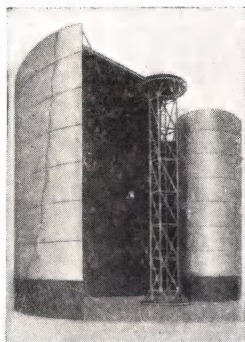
Полуразвёрнутый рулон, образующий стенки цилиндрич. резервуара.
